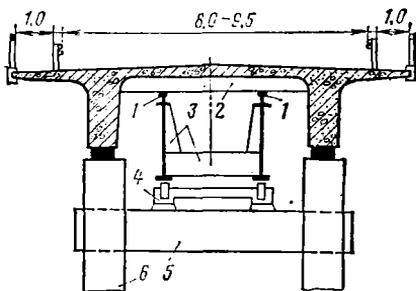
Схема расположения блоков составных плитно-ребристых пролетных строений на перемещающихся подмостях:
